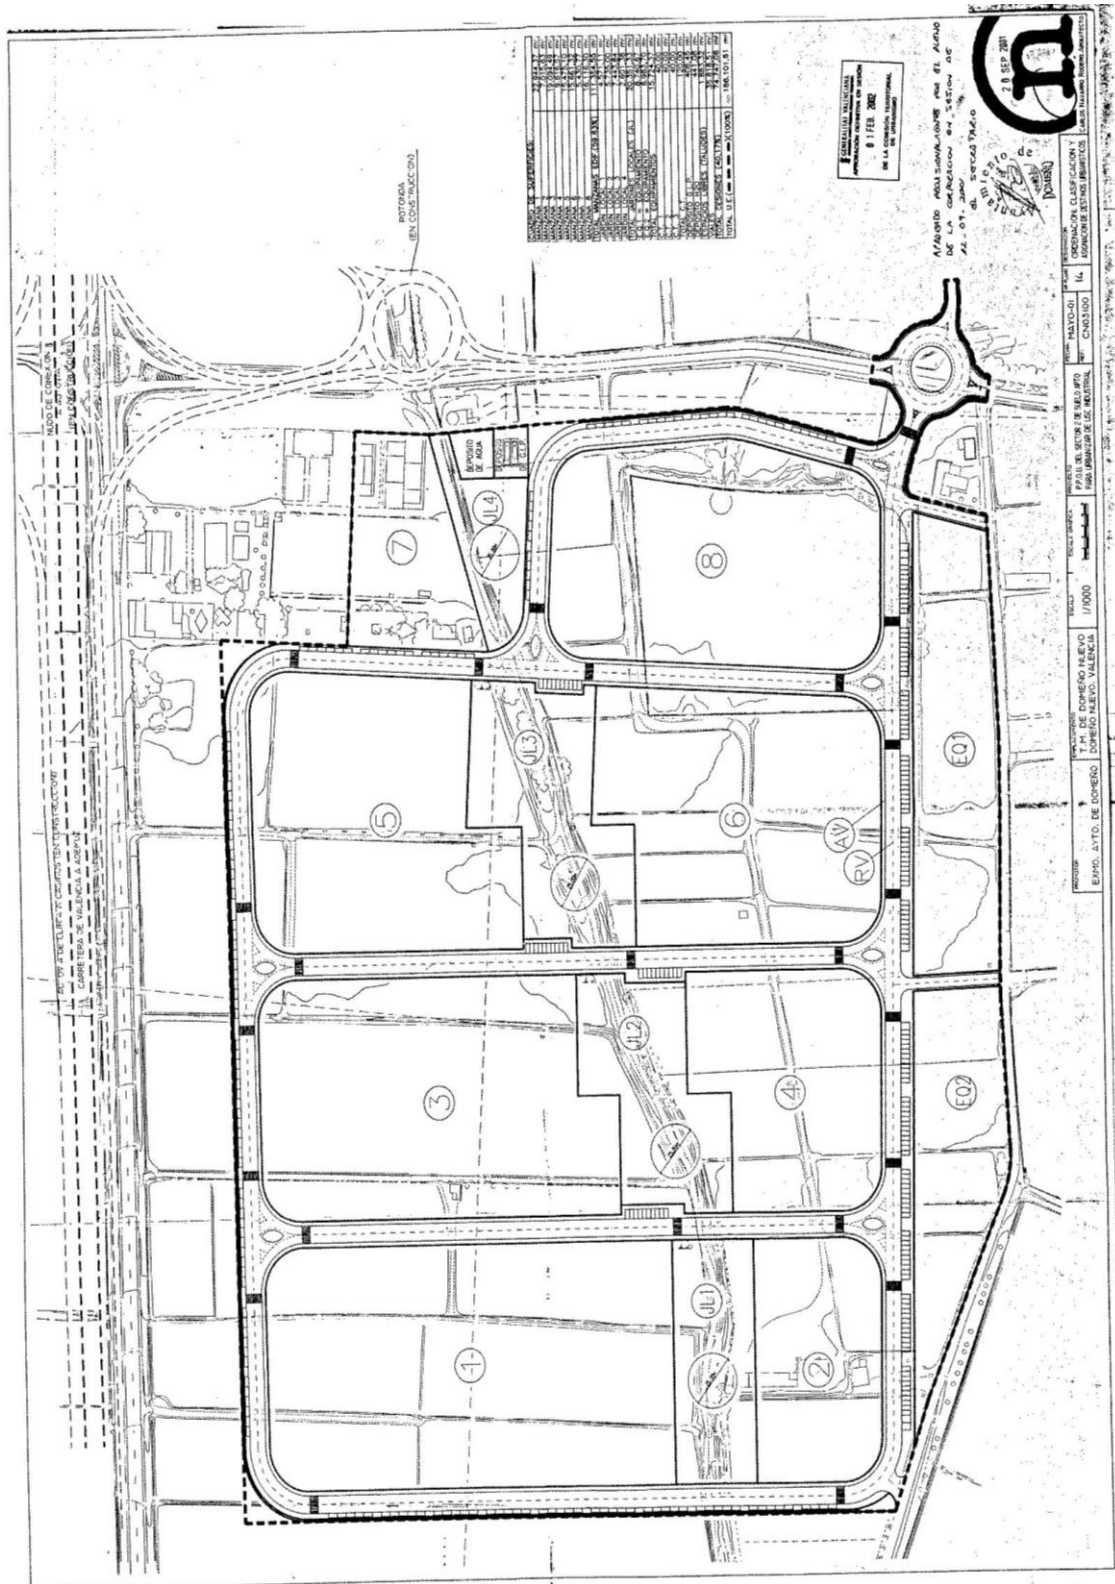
Plano del Plan Parcial (Domeño, 2001)
